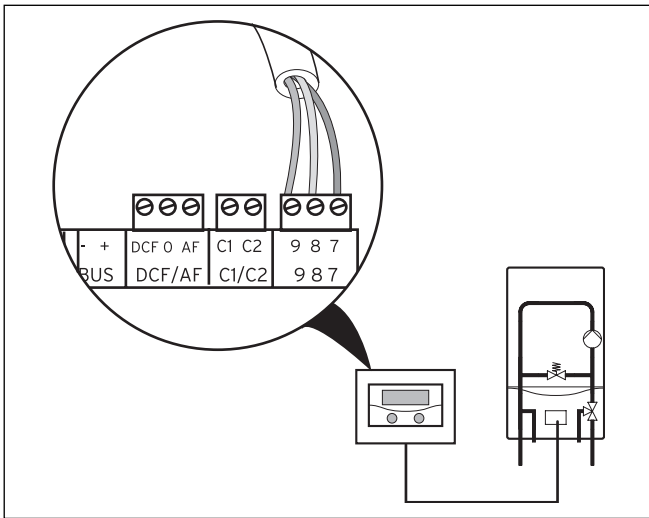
Collegamento dell'apparecchio di riscaldamento
